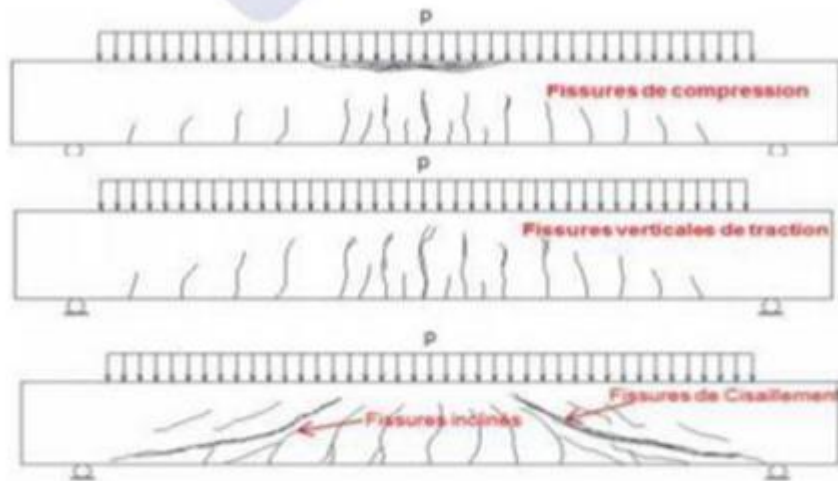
12 Modes de rupture des poutres en béton armé [6]
